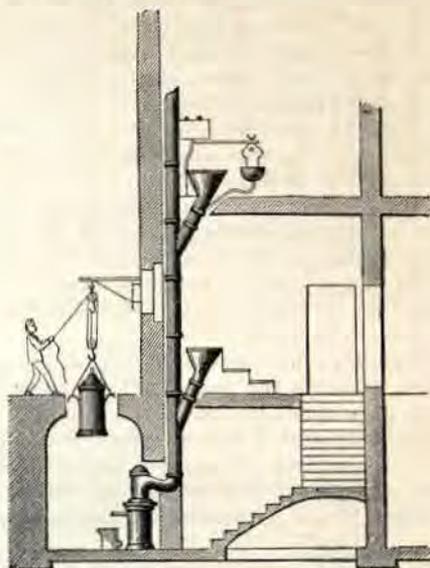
Elevation di un impianto di latrine a fosse mobili secondo il sistema adottato ad Eidelberga.
